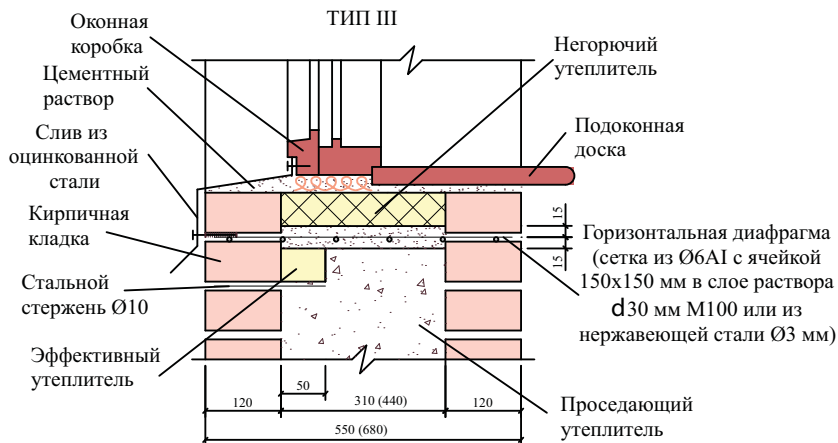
Подоконный узел наружной стены, в том числе из кирпичной кладки с вертикальными диафрагмами с проседающим утеплителем (тип III)
